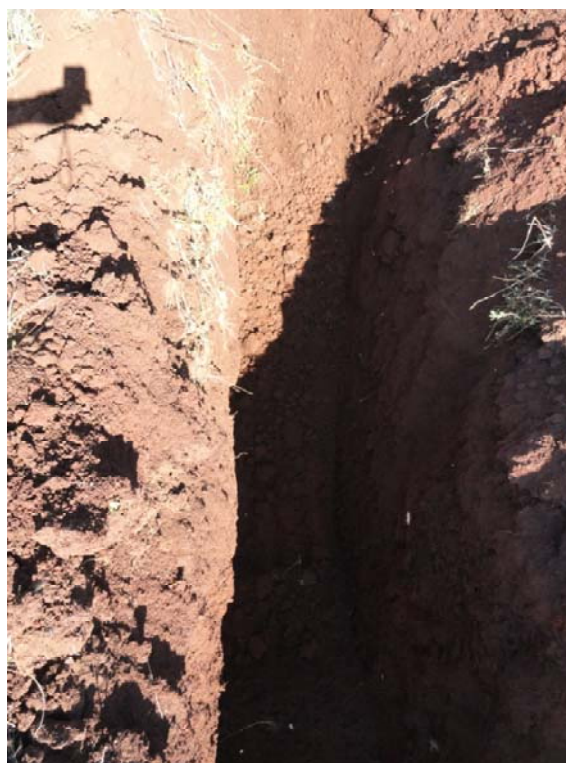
Sonia Ribeiro - PONTO 04 - TESTE DE INFILTRAÇÃO
